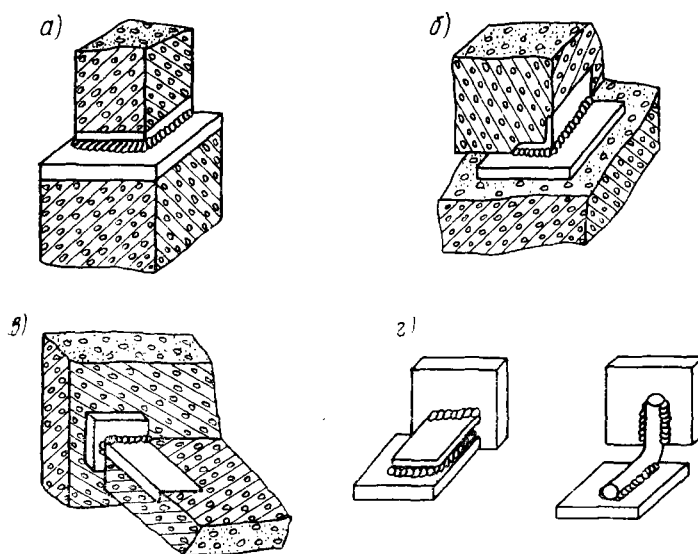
Монтажные сварные соединения сборных железобетонных элементов
